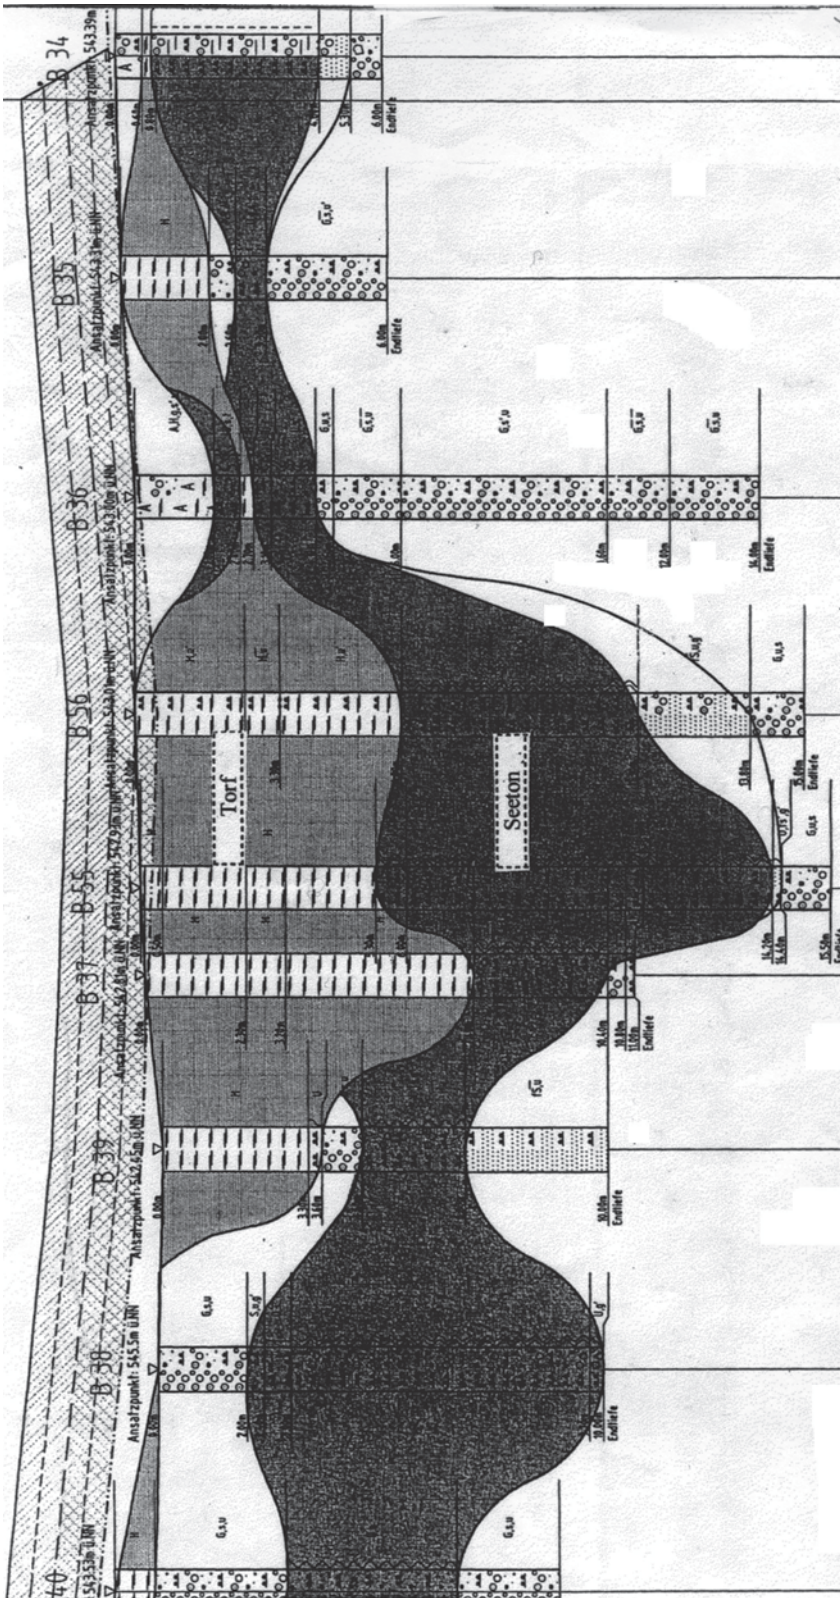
Auszug eines Baugrundprofils zu einer Sanddrainagründung
